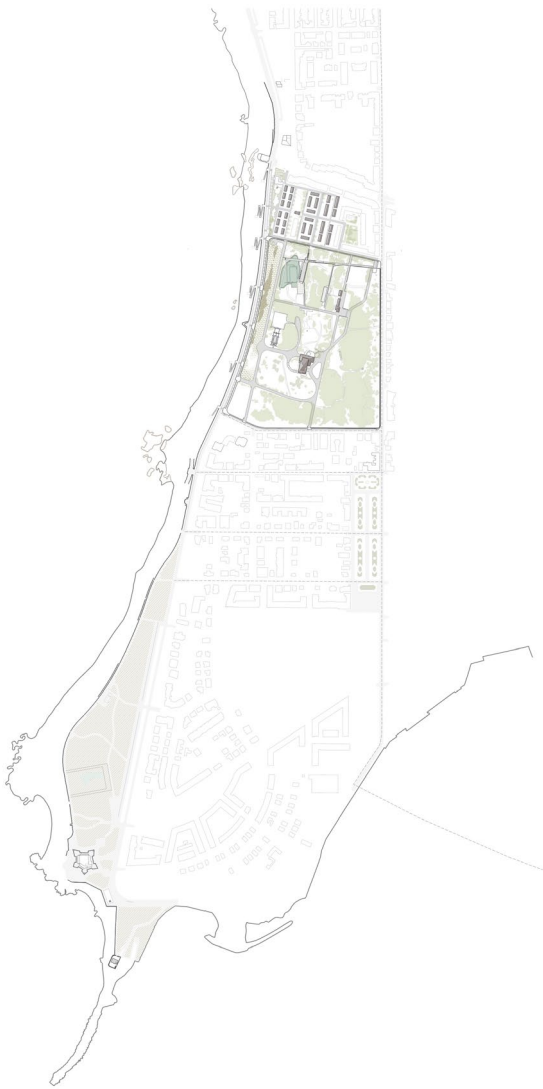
Plantas esquemáticas da estruturação da Proposta Integrada no Pinhal Menéres, elaborado pelo autor.
